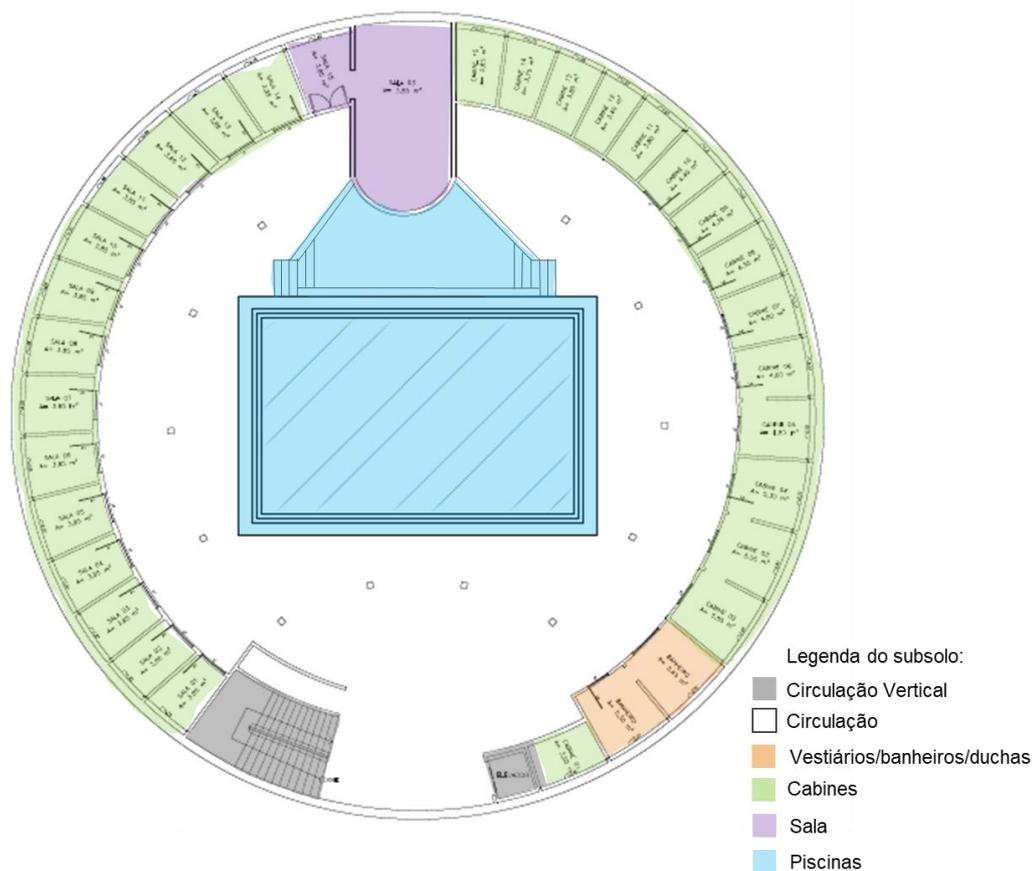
Esquema da planta baixa do pavimento subsolo do Balneário Osvaldo Cruz. Adaptado de (ARQUIVO DA PREFEITURA DE IRAÍ, 2021).
